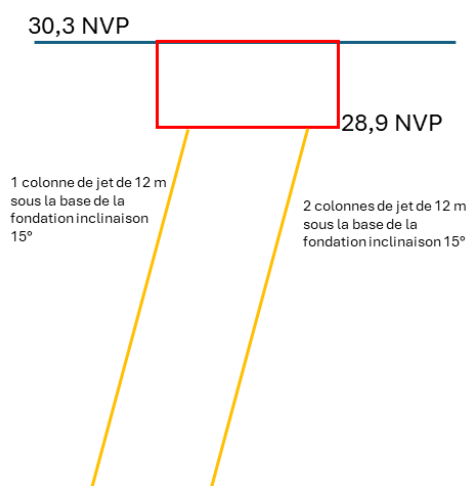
Schéma des tirs des lignes de colonnes de jet de la fondation des poteaux inclinés 1007 + 1008
